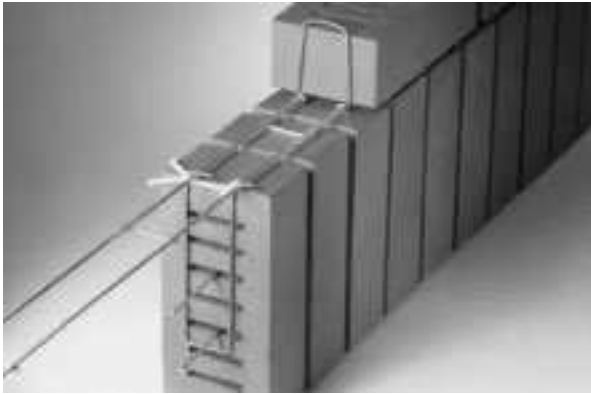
Bauaufsichtlich zugelassenes Sturzabwehrungssystem zur Überdeckung von Öffnungen bis zu 3,01 mm Breite (Elmenhorst)
